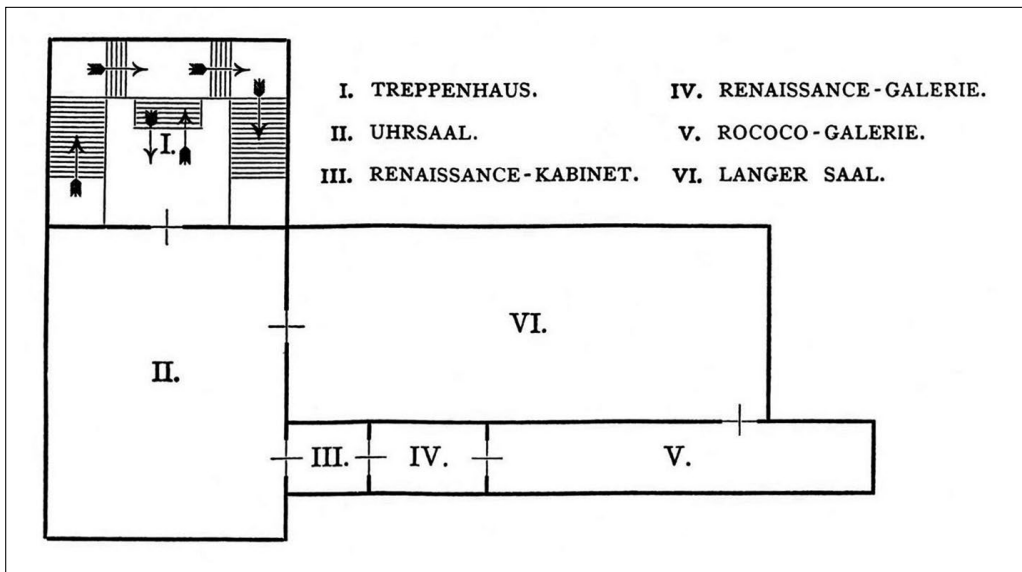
Grundriss der Ausstellungsräume in der Akademie der Künste, 1883.
